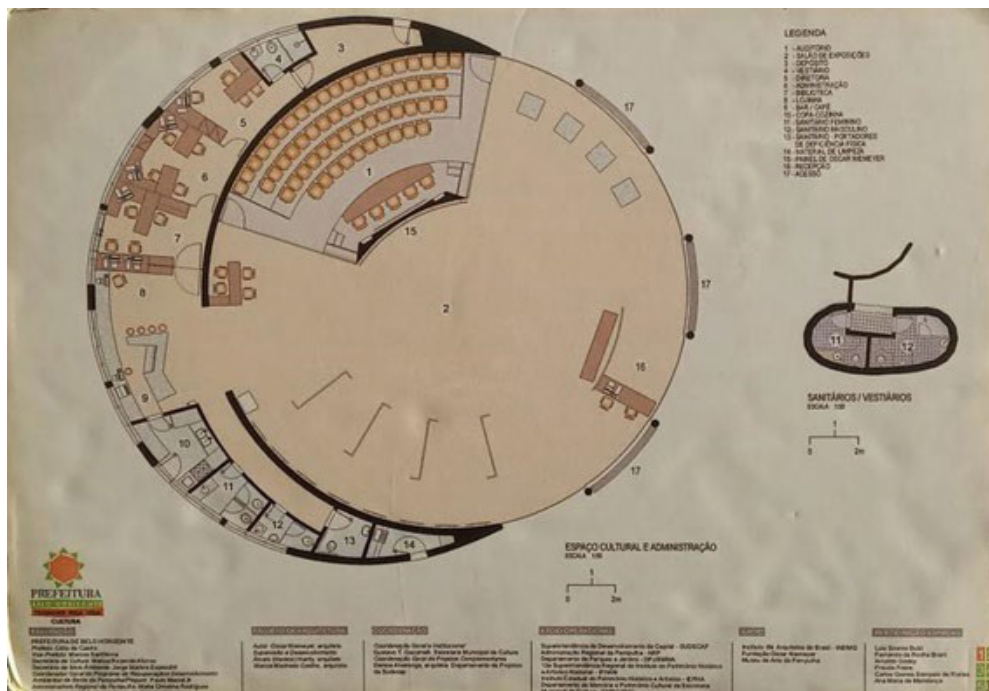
Croquis de Projeto de Restauração da Casa do Baile, s/d.
